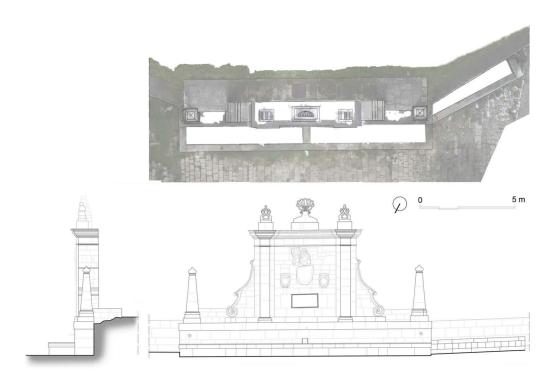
Rappresentazione in pianta e prospetto della fontana del Re. Elaborazioni grafiche di Arianna Lo Pilato.
